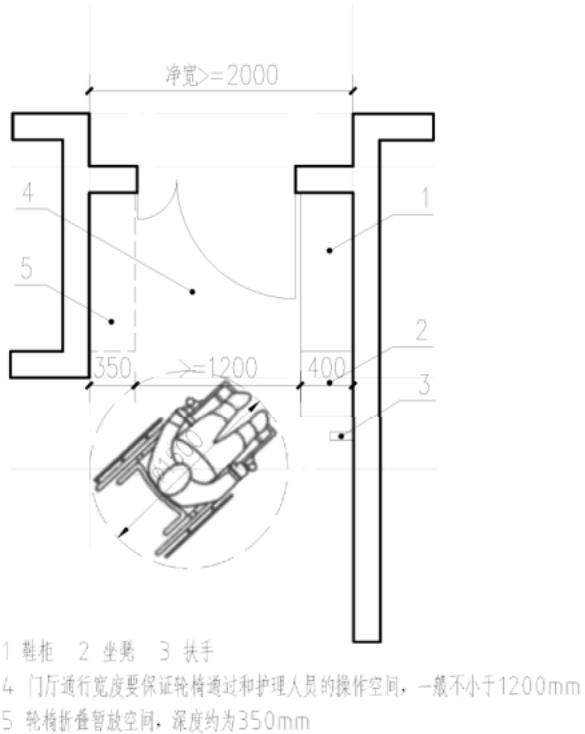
老年建筑门厅的平面基本尺寸示意图(尺寸单位: mm)
